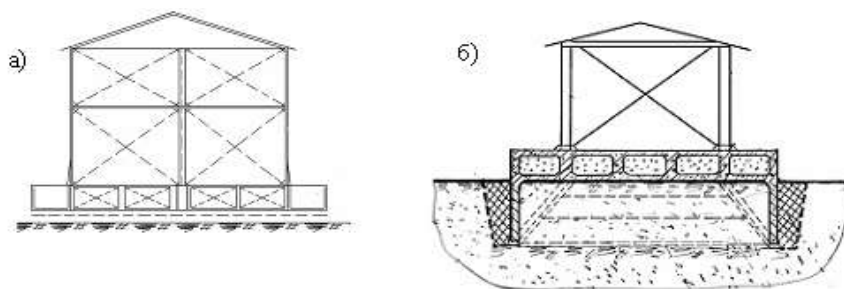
Примеры малоэтажных зданий замкнутого типа для строительства в сейсмических районах в сложных грунтовых условиях, объединенных с пространственной фундаментной платформой: а) незаглубленное со скользящим слоем; б) конструкция «стена в грунте. а) патент РФ № 2215852, б) патент РФ № 64650
